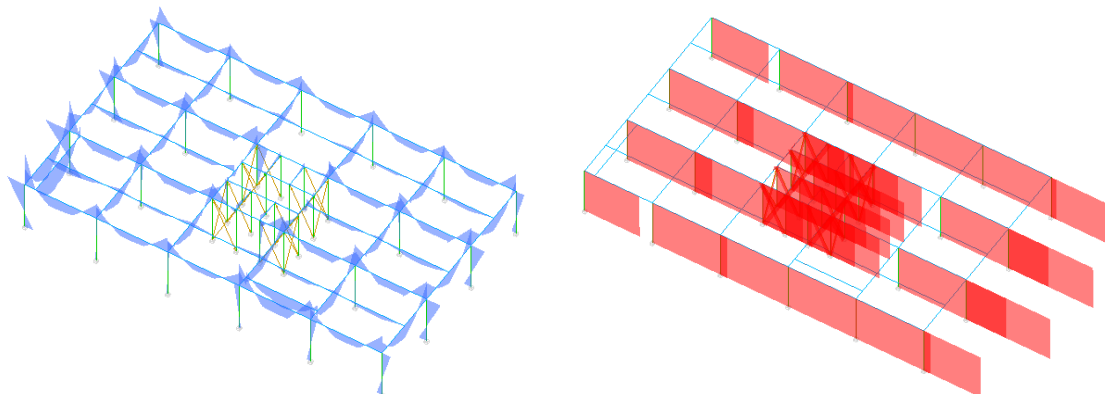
Diagramas de momentos flectores en vigas y esfuerzos axiales en pilares en planta baja
